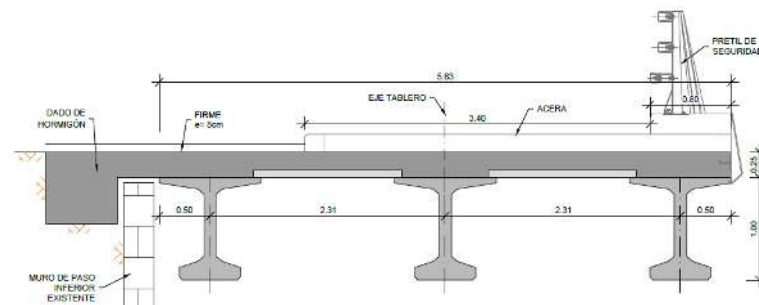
Sección transversal. Estructura E-5. Alternativa 3B
